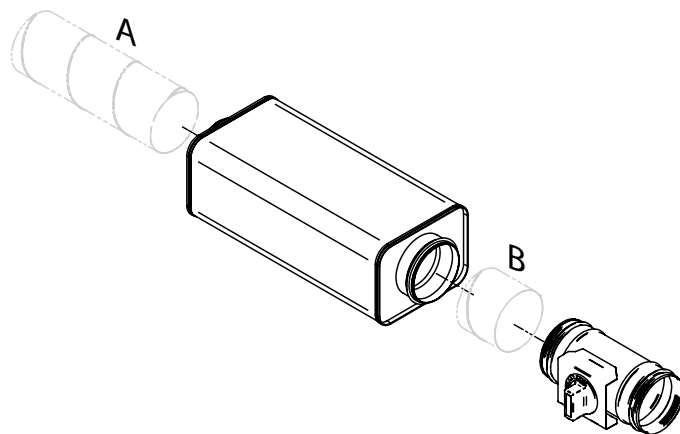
Zuluftkit PARAGON T-SAK-CAV-125
